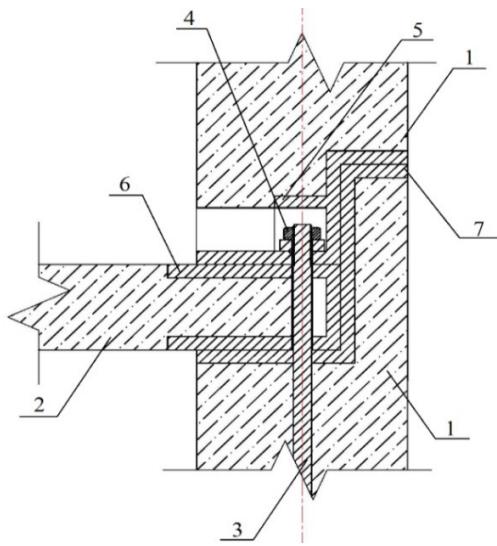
Узел сопряжения стеновых панелей и плиты перекрытия:
